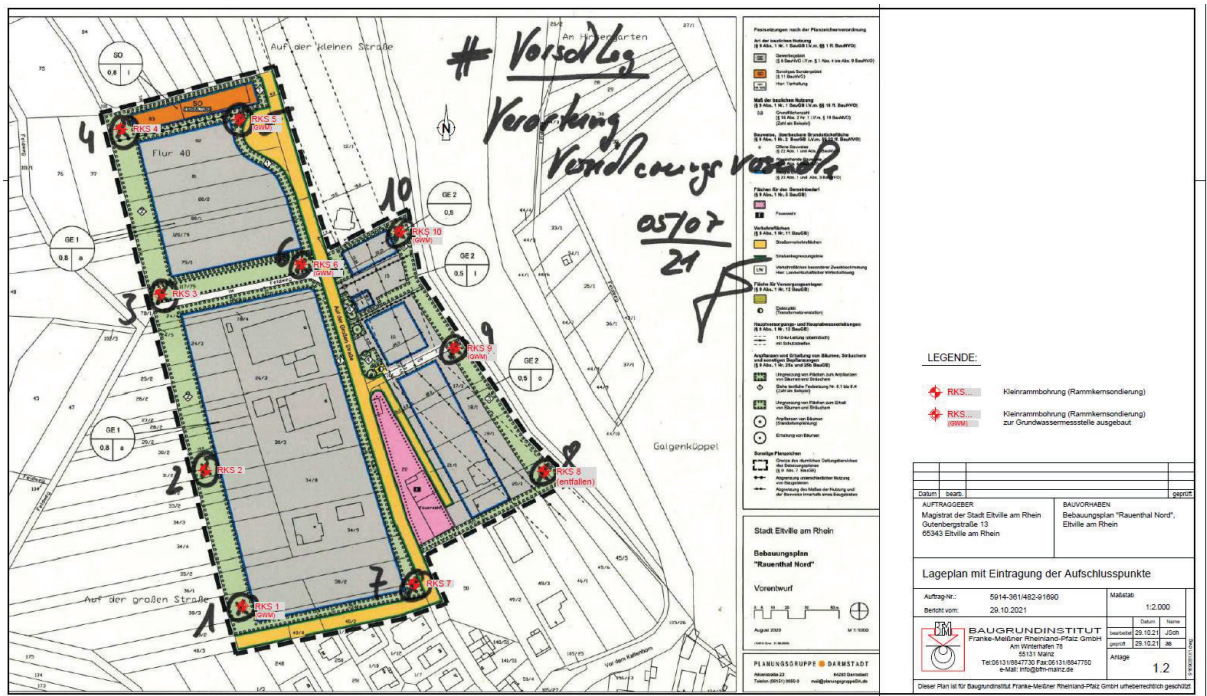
Lageplan mit Eintragung der Aufschlusspunkte, Baugrundinstitut Franke-Meißner 2021
